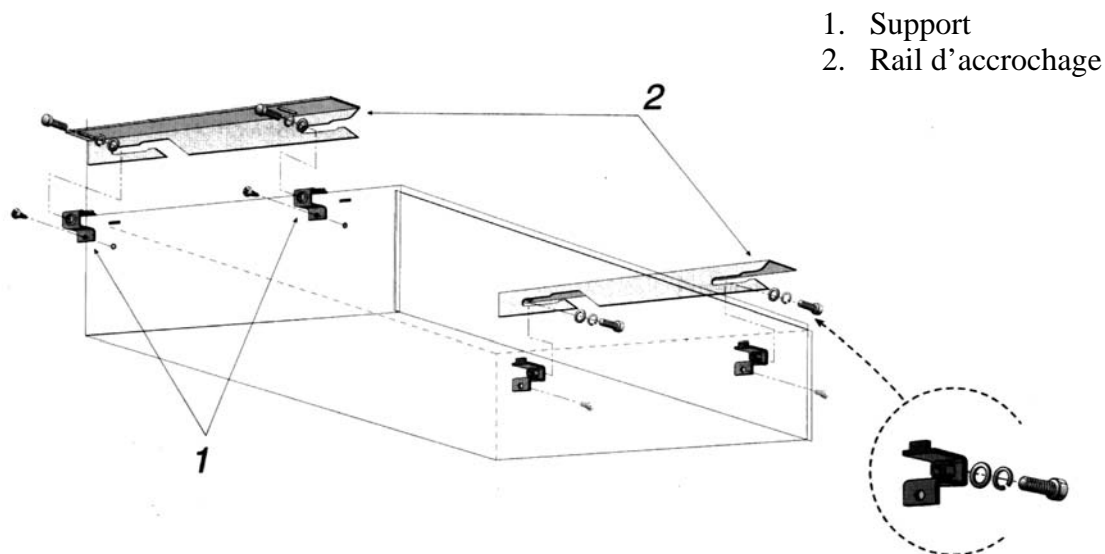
Schéma de principe de fixation d'une unité terminale plafonnière.
